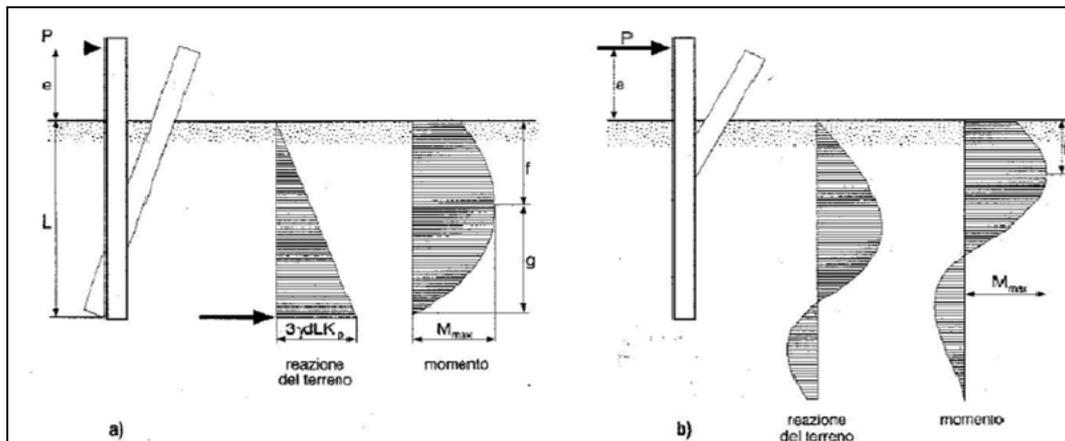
schematizzazione dell'azione del terreno su un palo infisso secondo Broms
